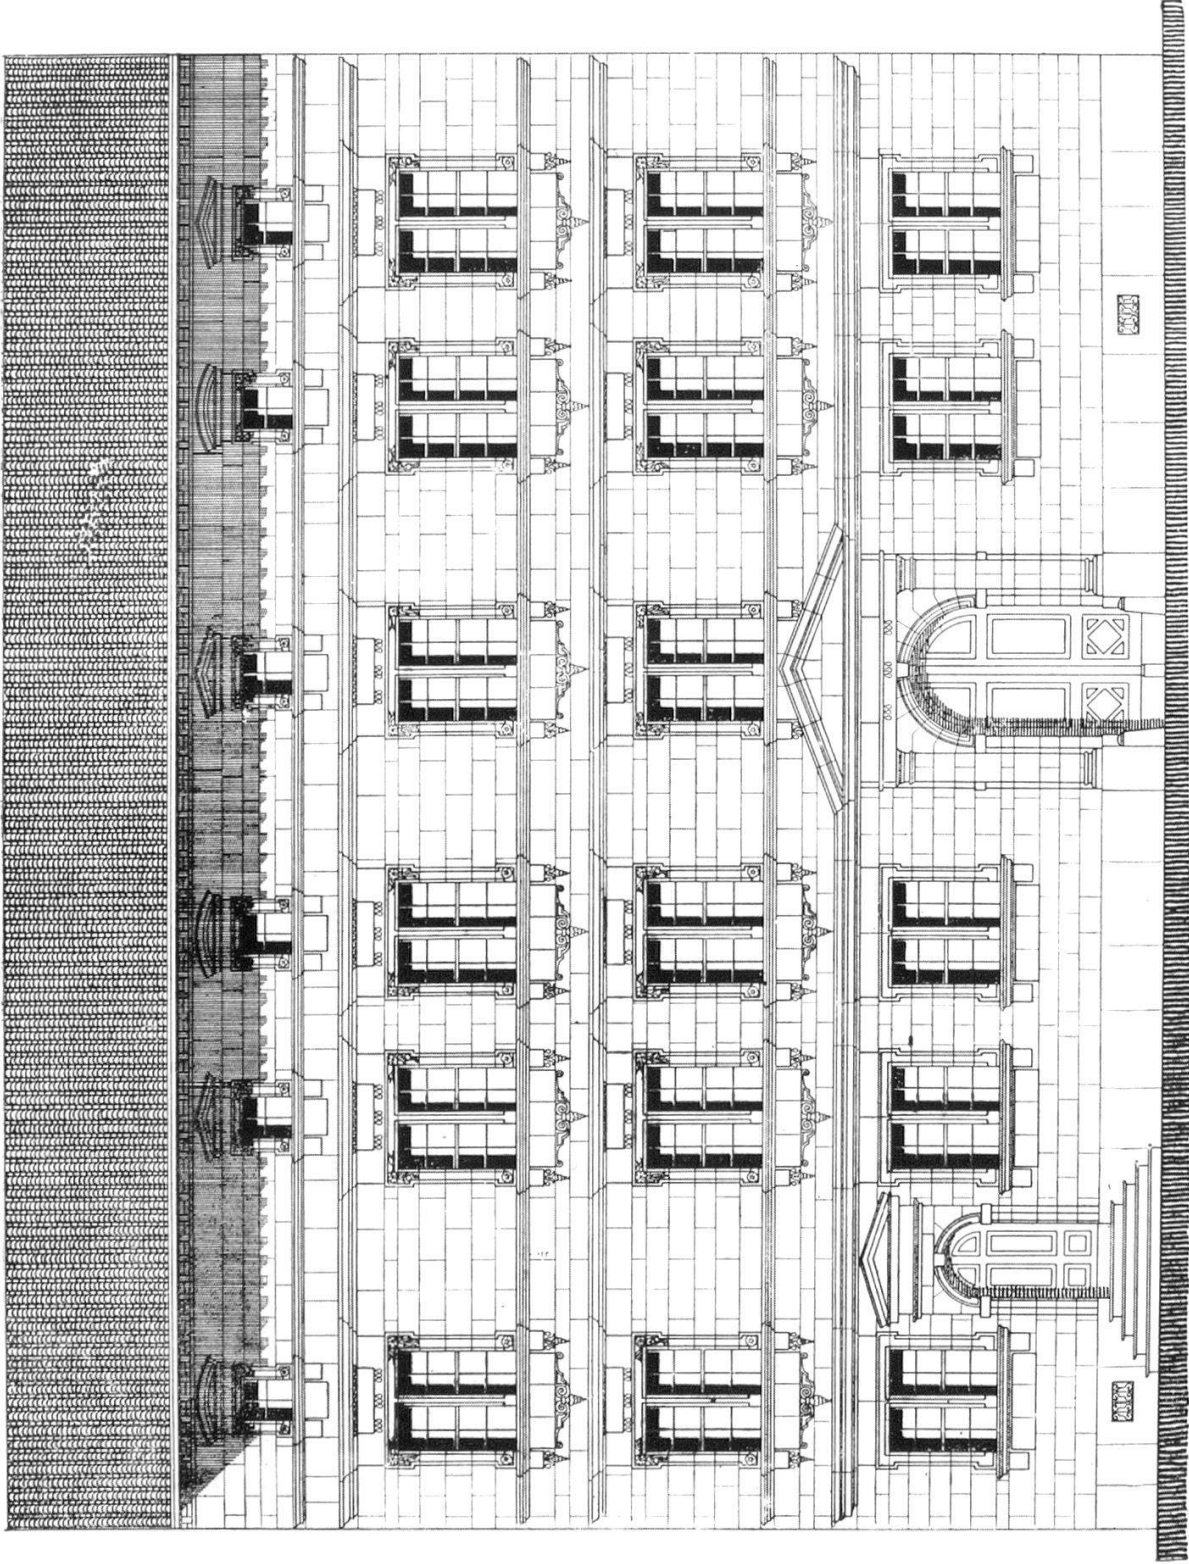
Genf, Haus Turrettini 1618/20, Nordfassade
